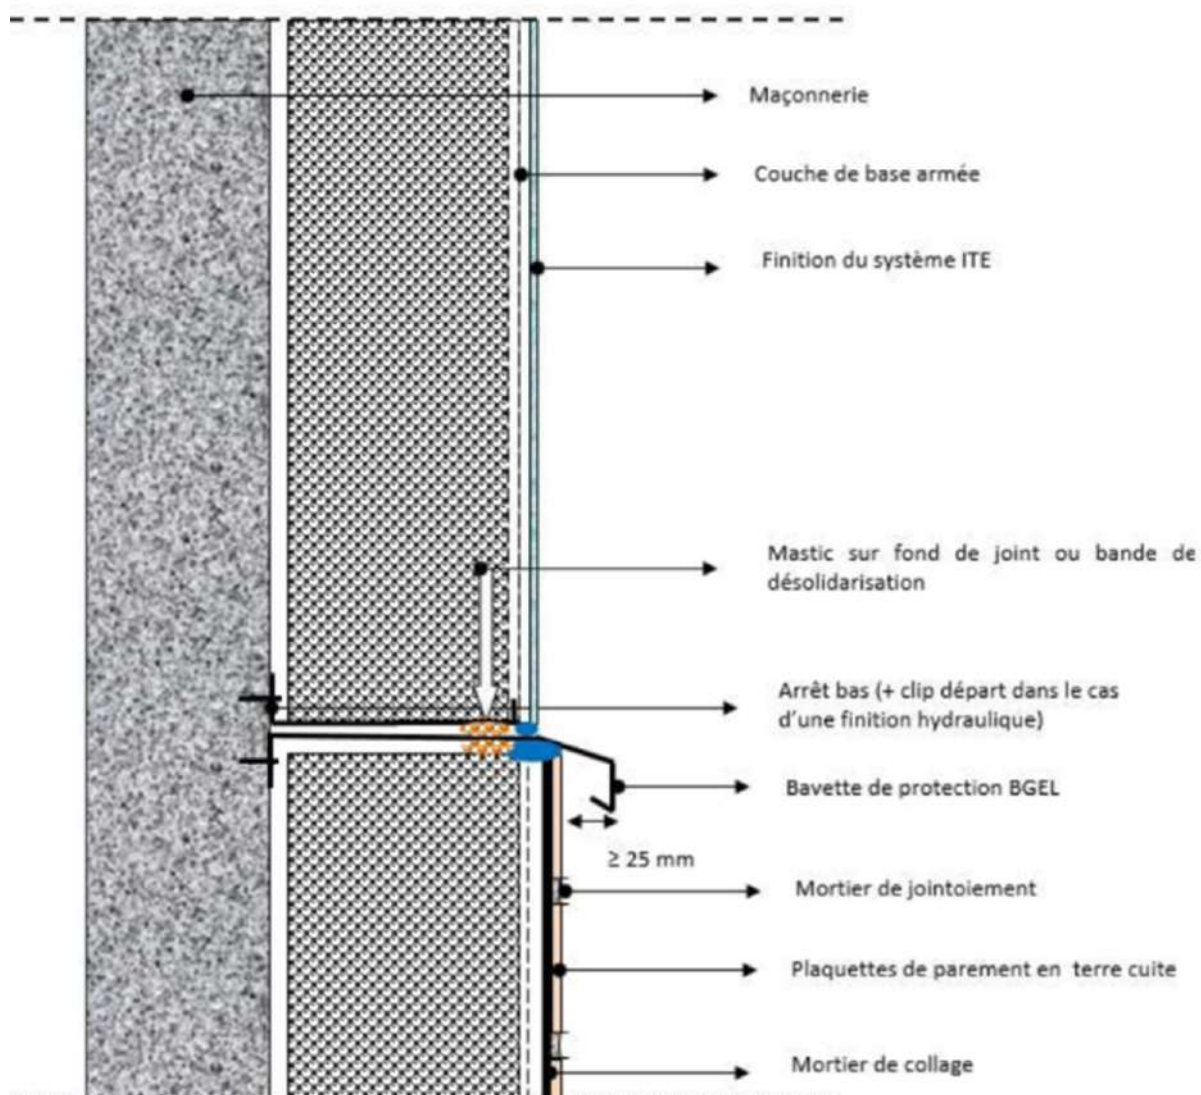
Finitions plaquettes de parement en terre cuite : raccordement avec un système d'enduit sur isolant avec utilisation d'une bavette (la fixation des panneaux isolants sur la maçonnerie n'est pas symbolisée)
